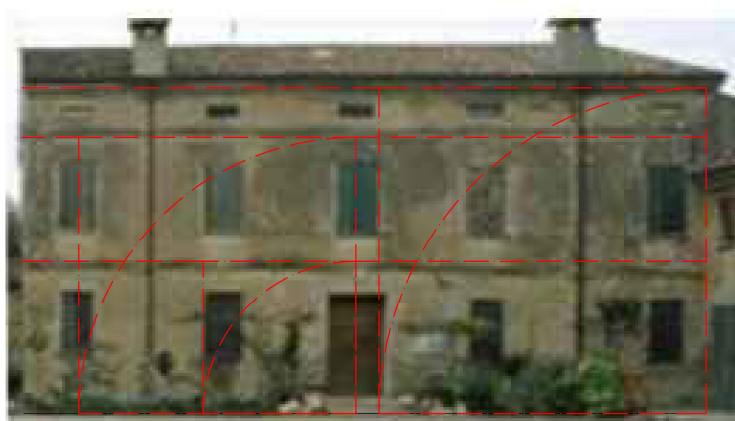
Tracciati regolatori prospetto principale casa padronale di Corte Bardella
